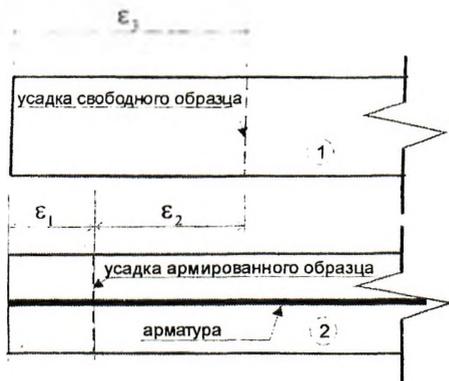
К расчёту напряжений в бетоне при ограничивающем действии арматуры
